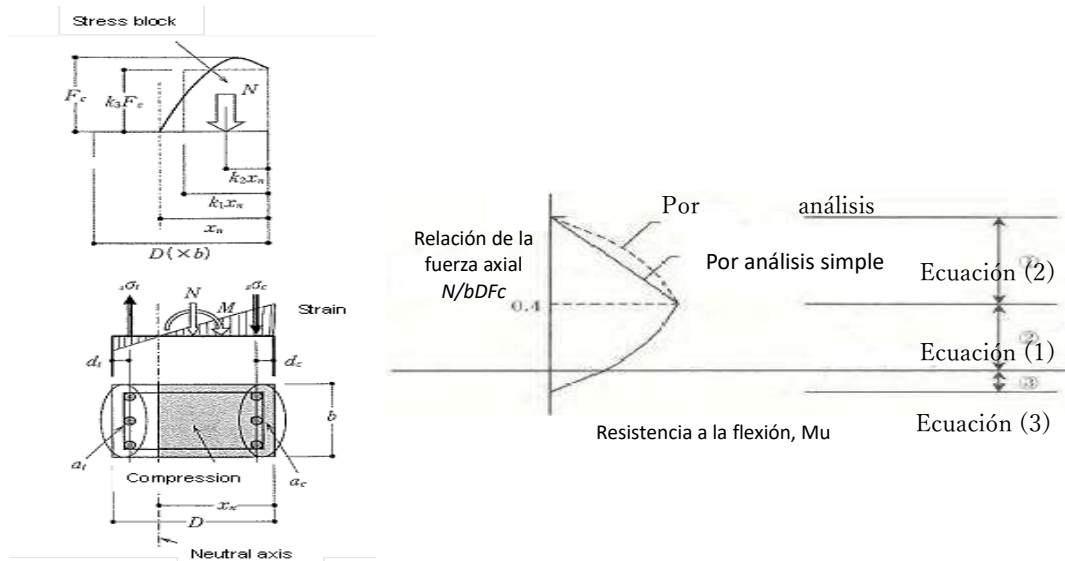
Supuesta Distribución de esfuerzo de hormigón y refuerzo (izquierda) e Interacción de Columna (derecha) (Fuente; JSCA, Japón, "Guía de Diseño Sísmico para Edificios")
